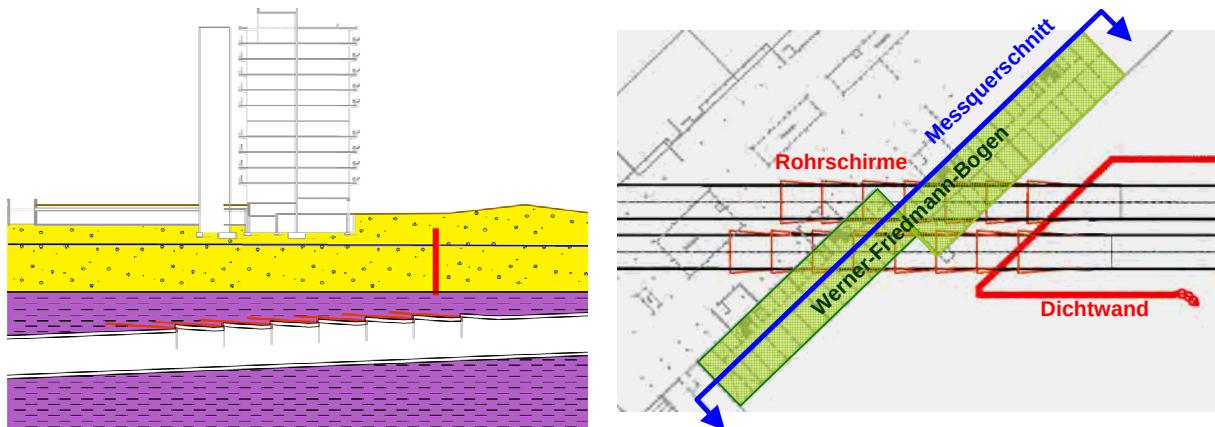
Unterfahrung Werner-Friedmann-Bogen im Längsschnitt und Lageplan
